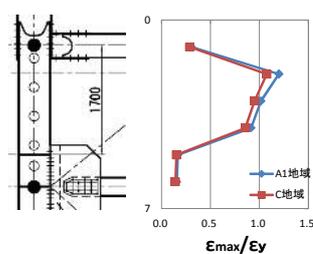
補剛桁上弦材(断面A) (点⑭~⑮間)
